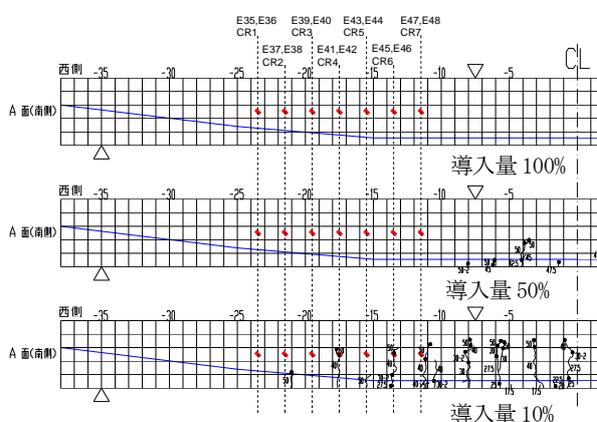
載荷荷重 50kN 時のひび割れ図
